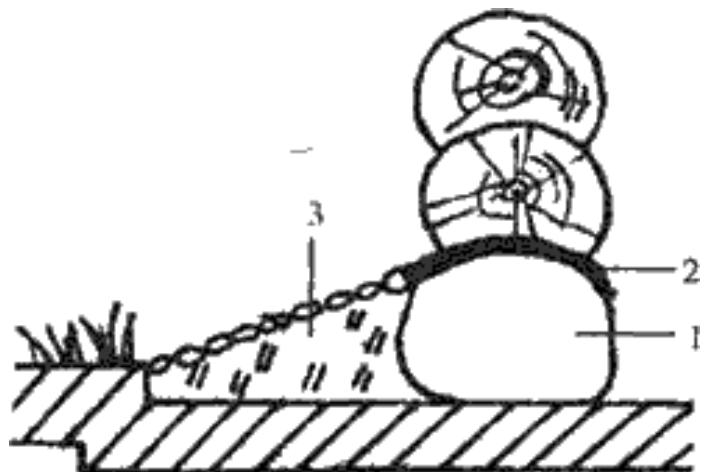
Фундамент из природного камня: 1 — камень; 2 — гидроизоляция; 3 — глиняная отмосица.
